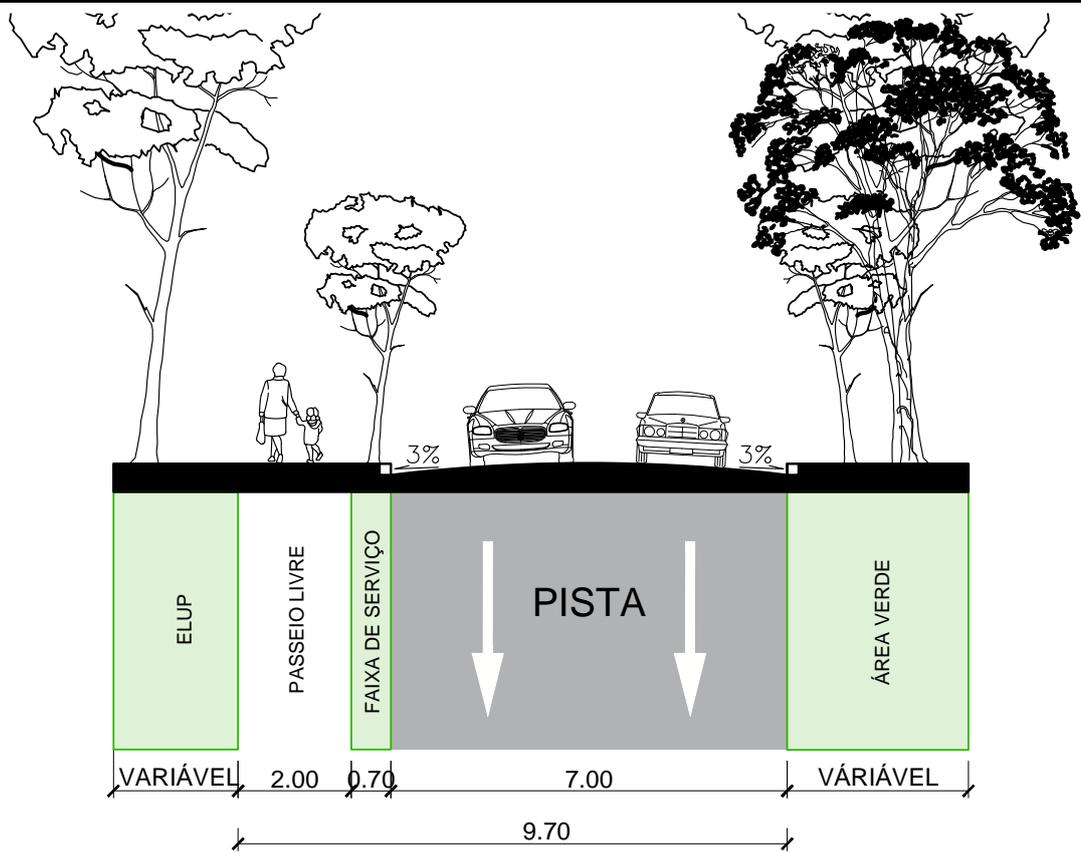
Perfil 08 – Rua Parque do Cerrado (acesso a partir da DF 140)
